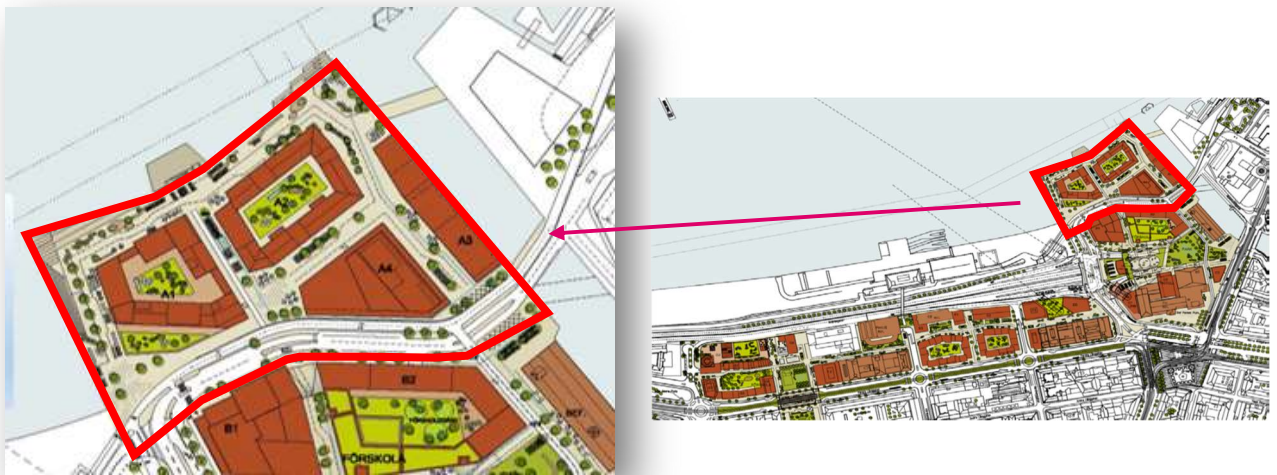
Halvöns omfattning i plan samt fastighetsägare, A1 Stena fastigheter, A2 Stena Fastigheter/Riksbyggen, A3 och A4 Elof Hansson, övrigt Allmän plats Fastighetsnämnden.
